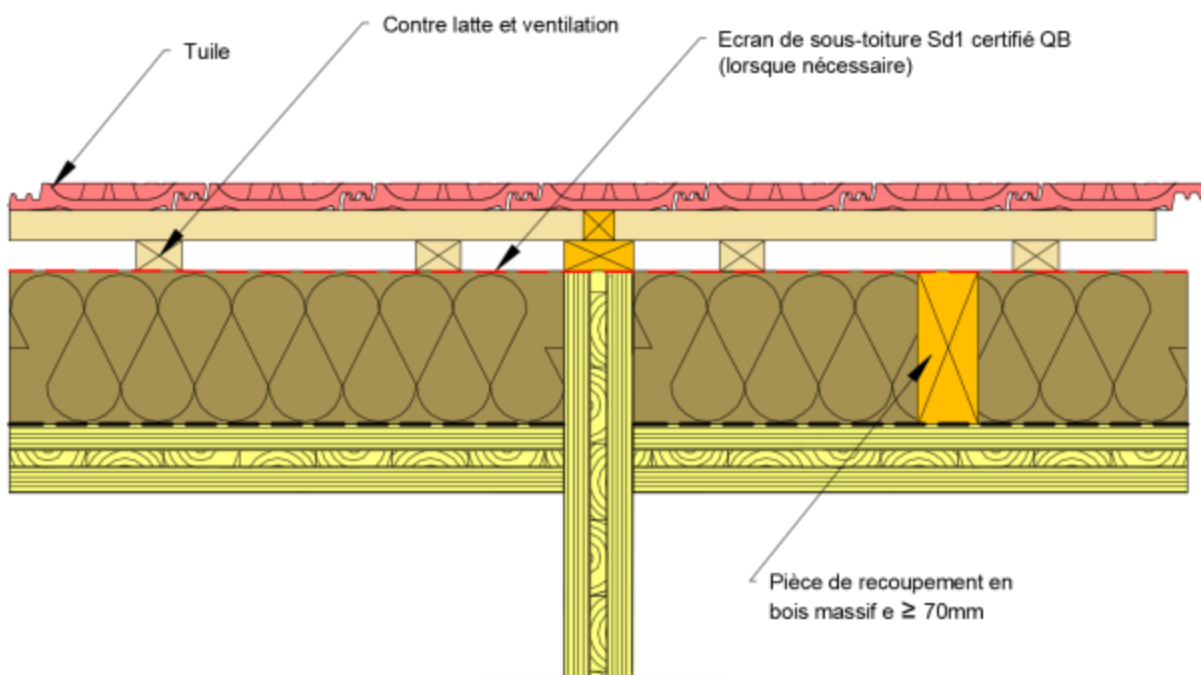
Détail de recoupement au droit des écrans de cantonnement : simple mur - Climat de plaine
